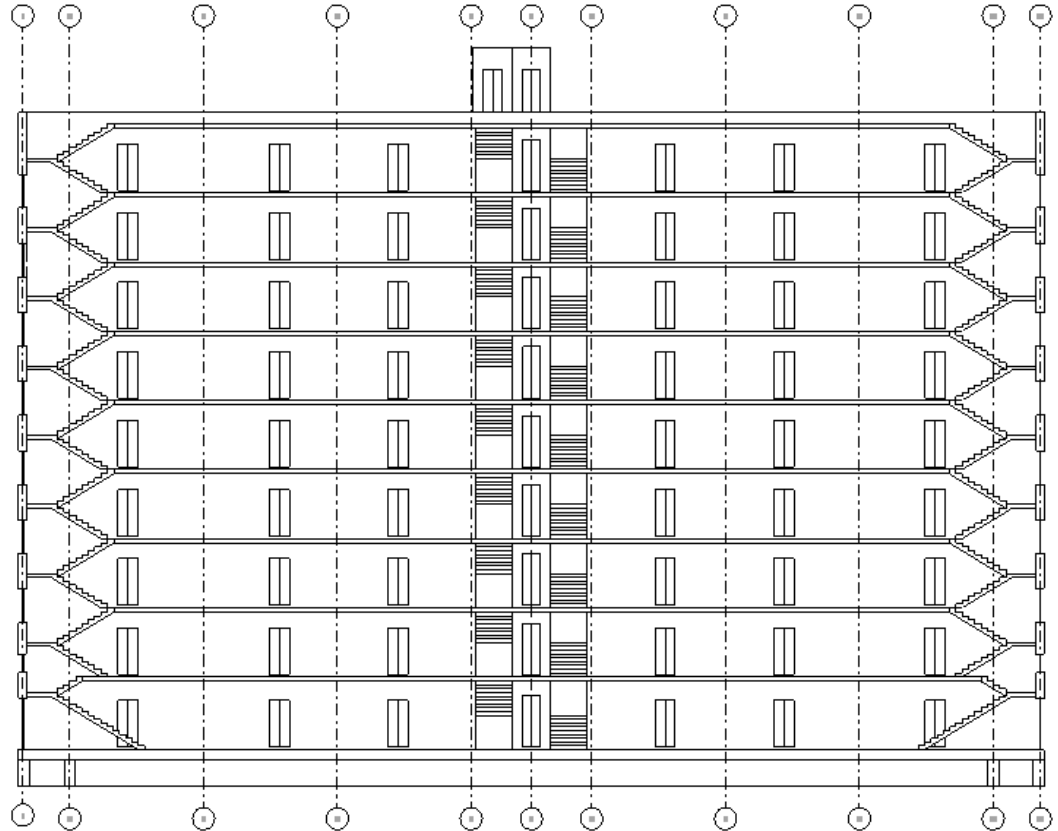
Розріз по головному фасаді будівлі 2 – го типу
